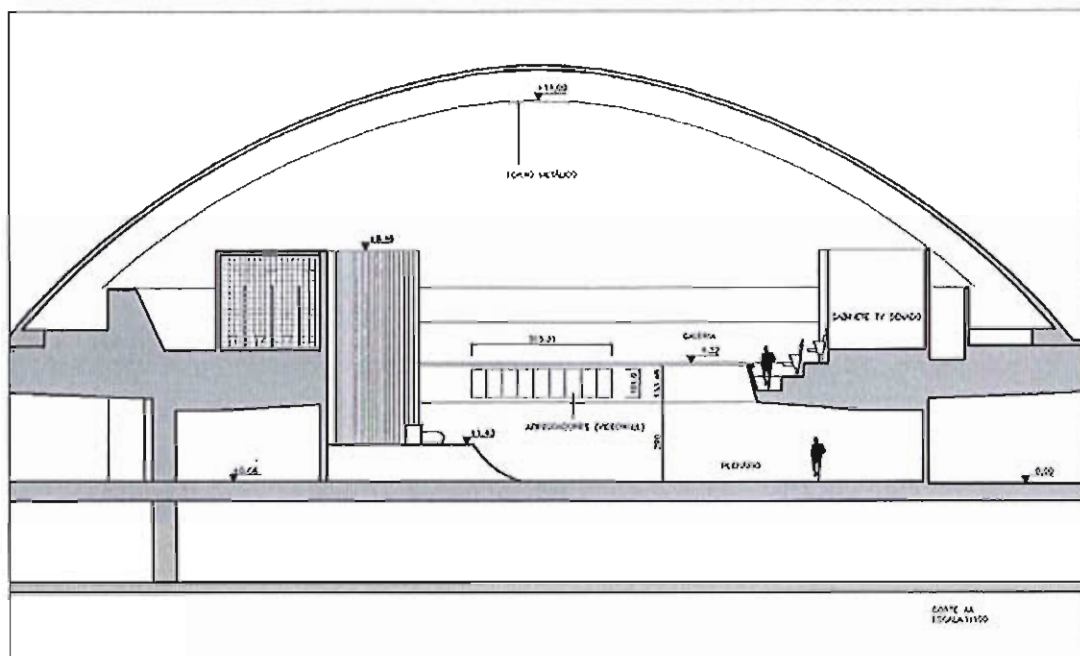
Corte - Localização dos painéis de Video Wall no Plenário.
